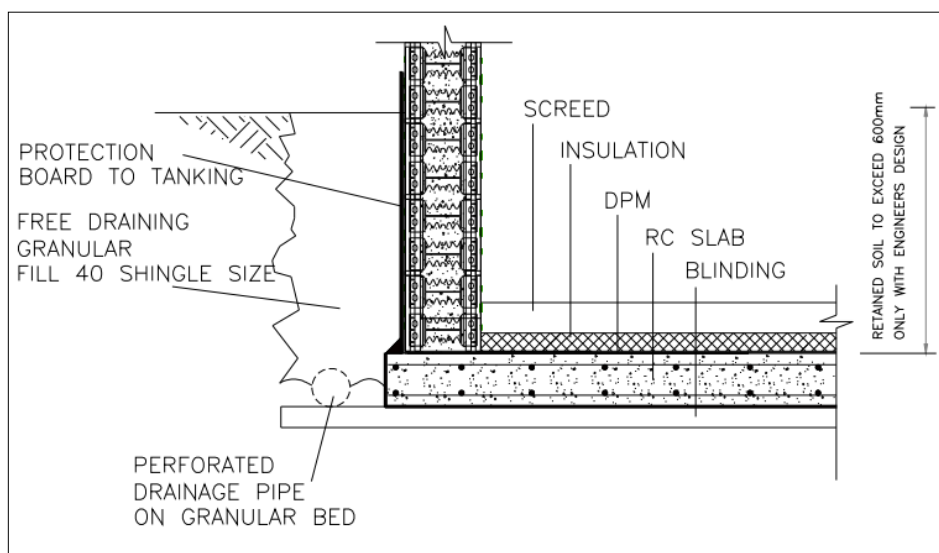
Secció vertical de façana construïda amb styroporsteine (Arranc des de fonamentació).
